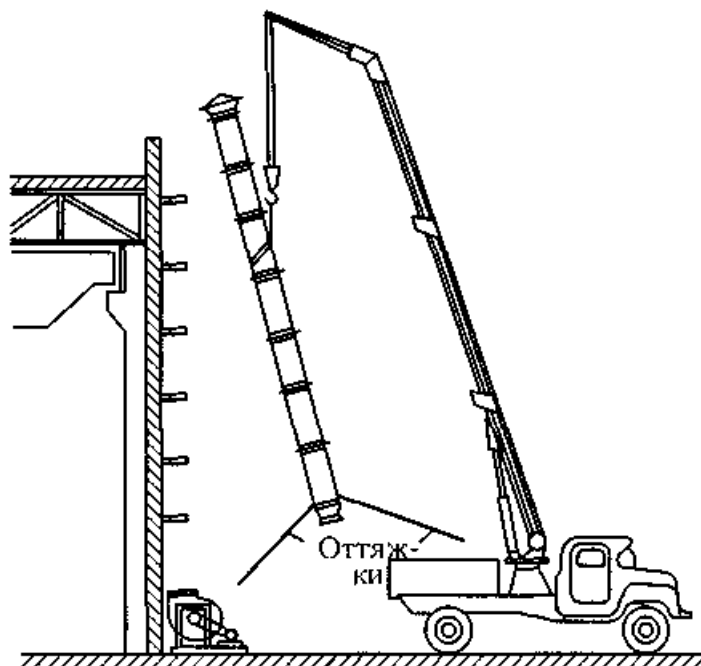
Монтаж вертикальных воздуховодов на наружной стене здания автомобильным краном
